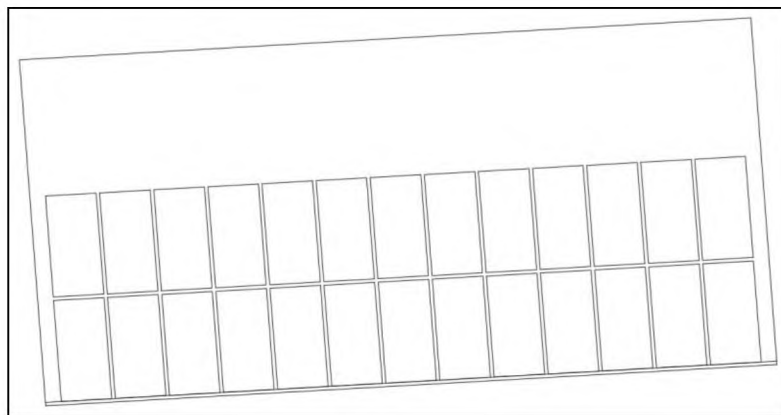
Distribución de paneles solares. Fuente: Grupo de investigación.
